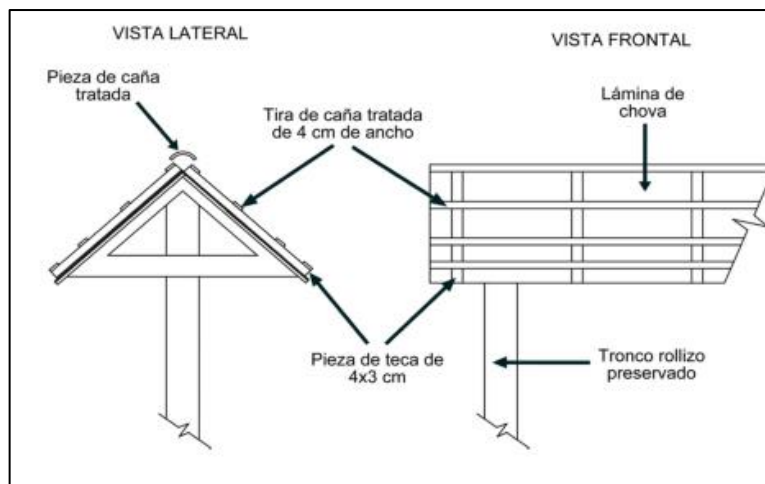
Detalles del armazón de madera para fijar las hojas de paja al techuelo
